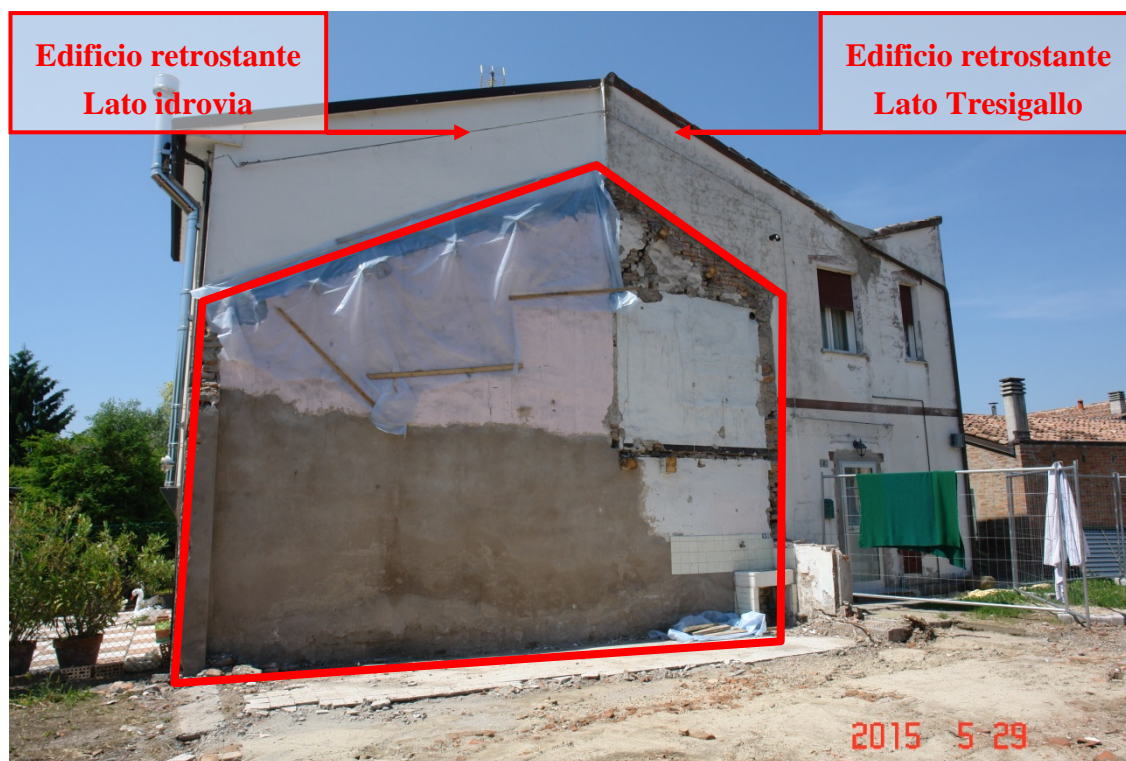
Porzione di fabbricato “3”: messa a vista della parete ovest
